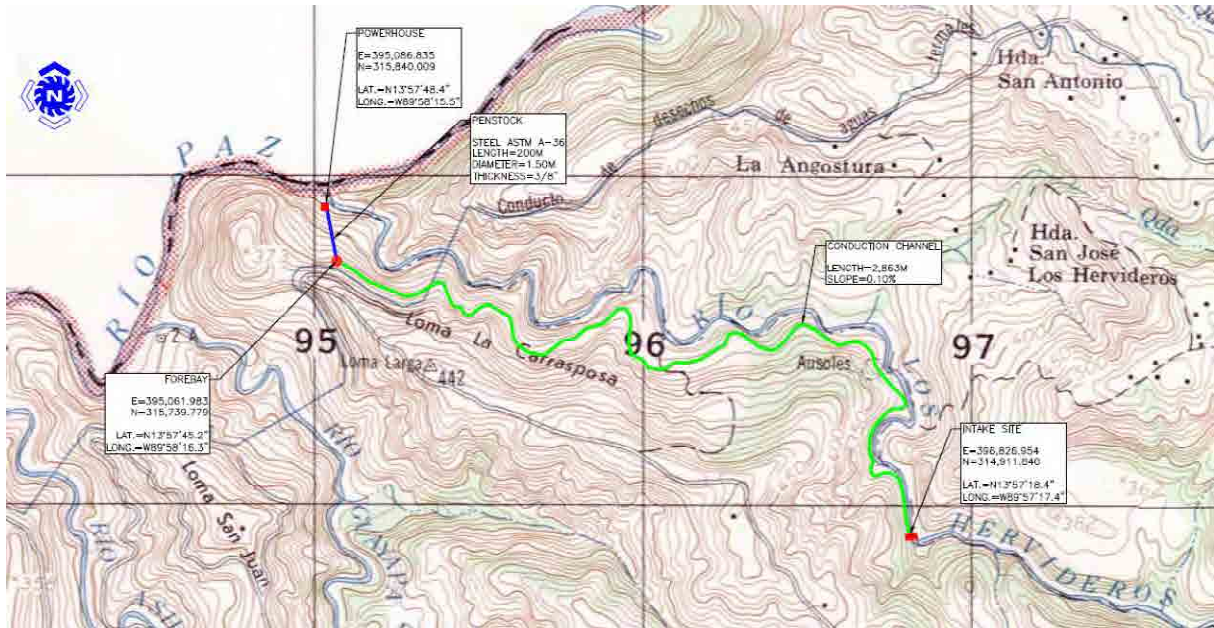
Plan General del Proyecto Los Hervideros I
